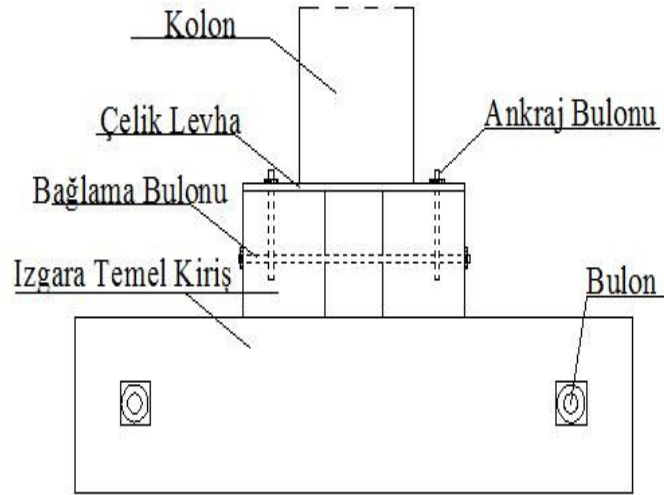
Prefabrik Filizli Temel Planı ve Kesiti
